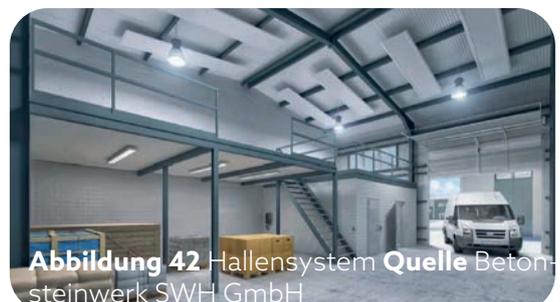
Hallensystem Quelle Betonsteinwerk SWH GmbH
